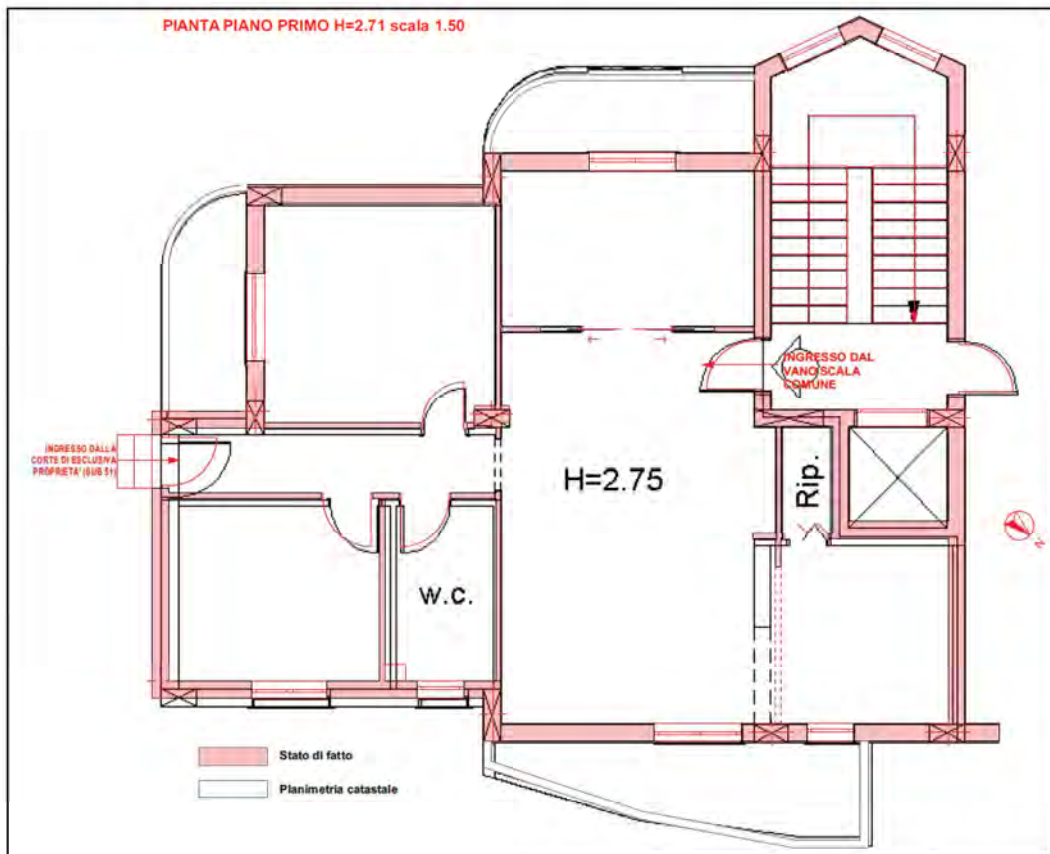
Sovrapposizione visura planimetrica catastale dell'appartamento pignorato (foglio 74 particella 709 sub 1-51) e rilievo effettuato in fase di sopralluogo – Piano primo.
